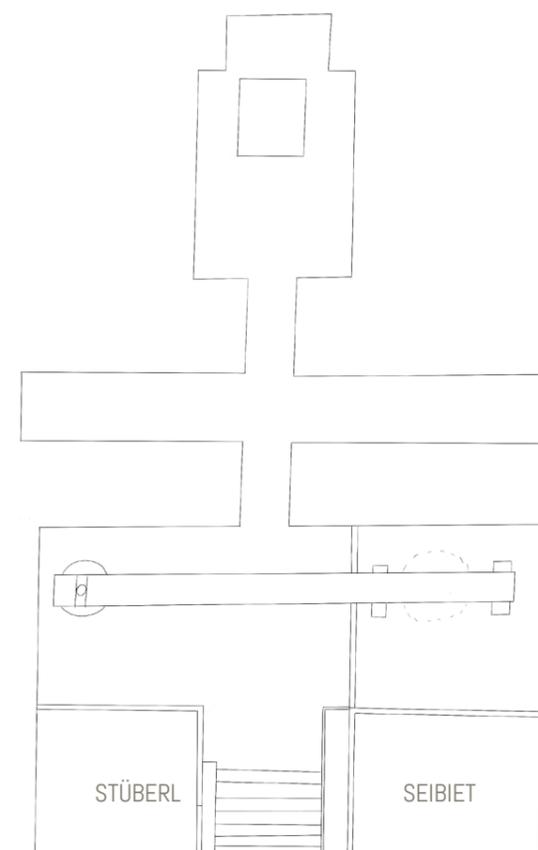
Grundriss Presshaus Herr Winkler
